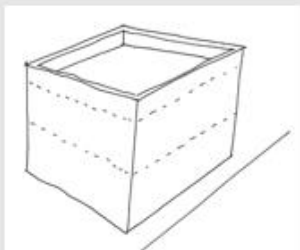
Hauteur d'une dépendance à toiture plate (en secteur protégé)
